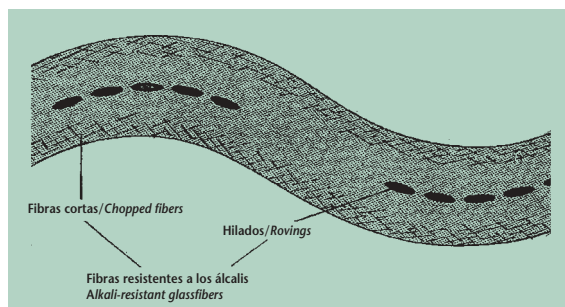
Corte transversal en un panel corrugado de hormigón con fibra de vidrio con fibras cortas y largas
